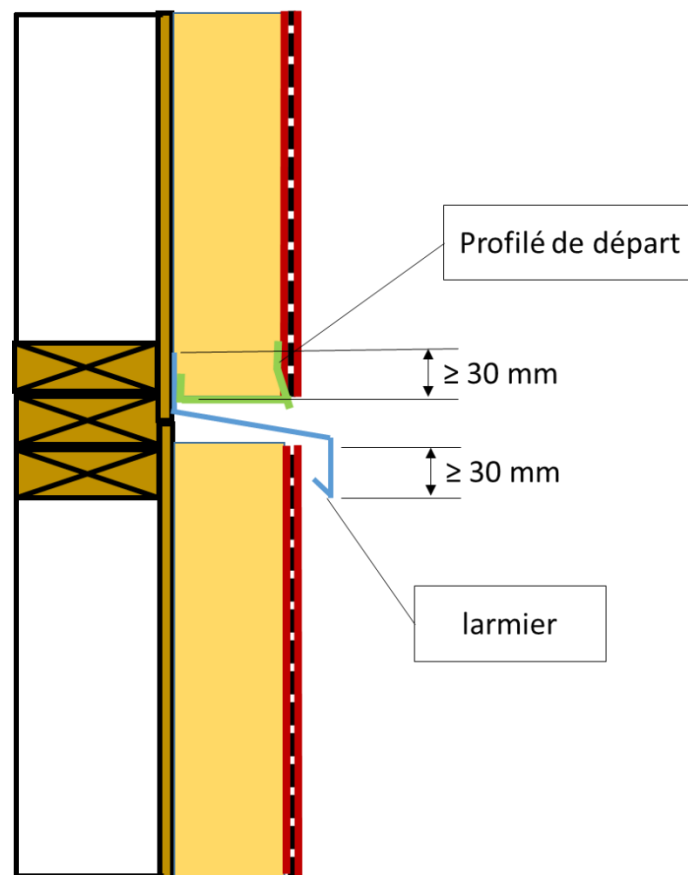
Recouvrement horizontal du système ETICS (Ee1) – coupe verticale
